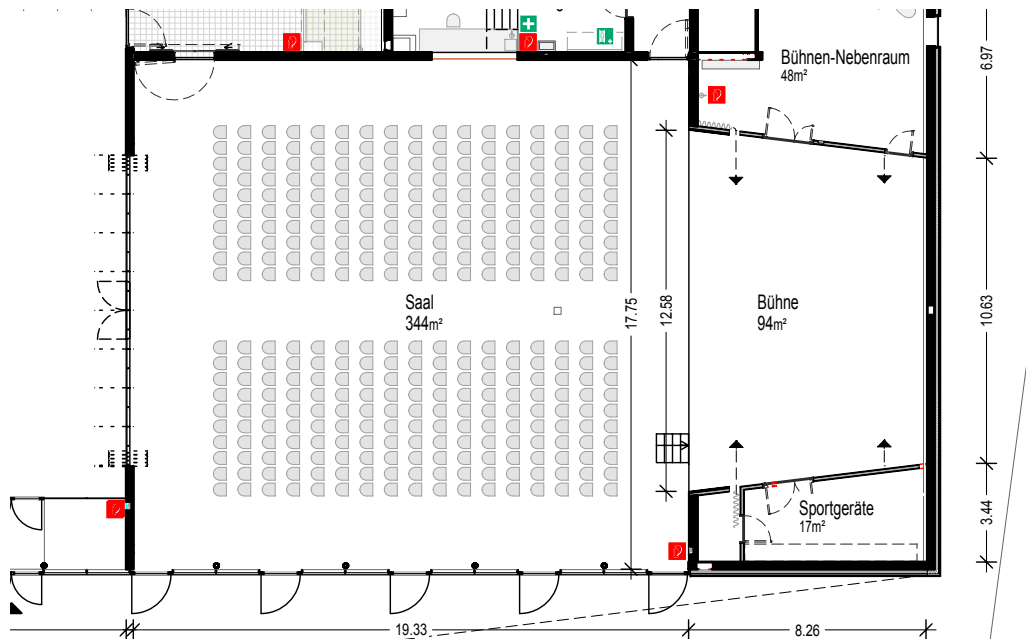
Grundriss des Saals der Kulturhalle Dusslingen
